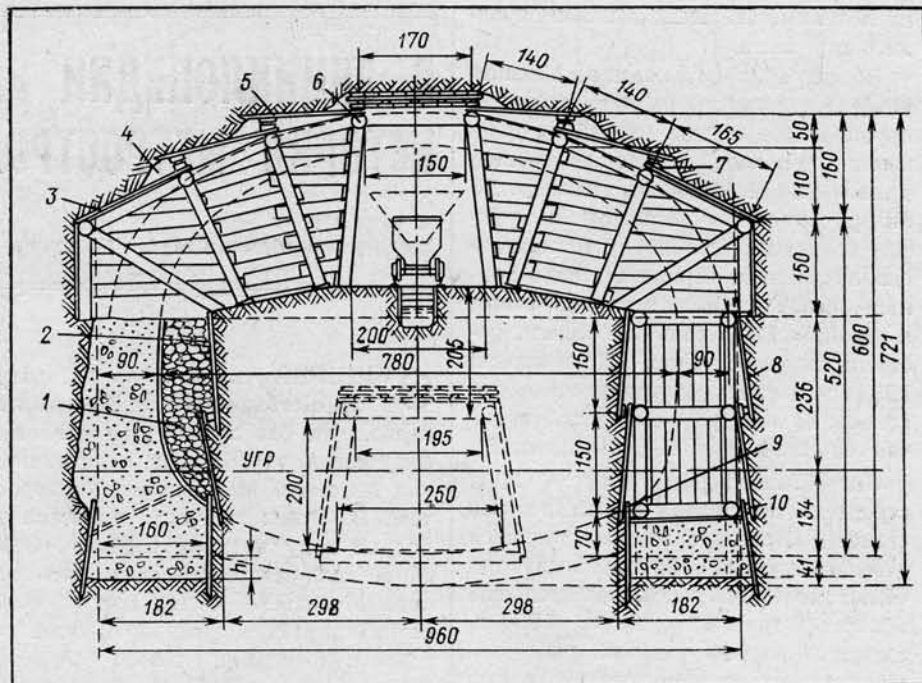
Разработка тоннеля с бетонированием стен в колодцах
